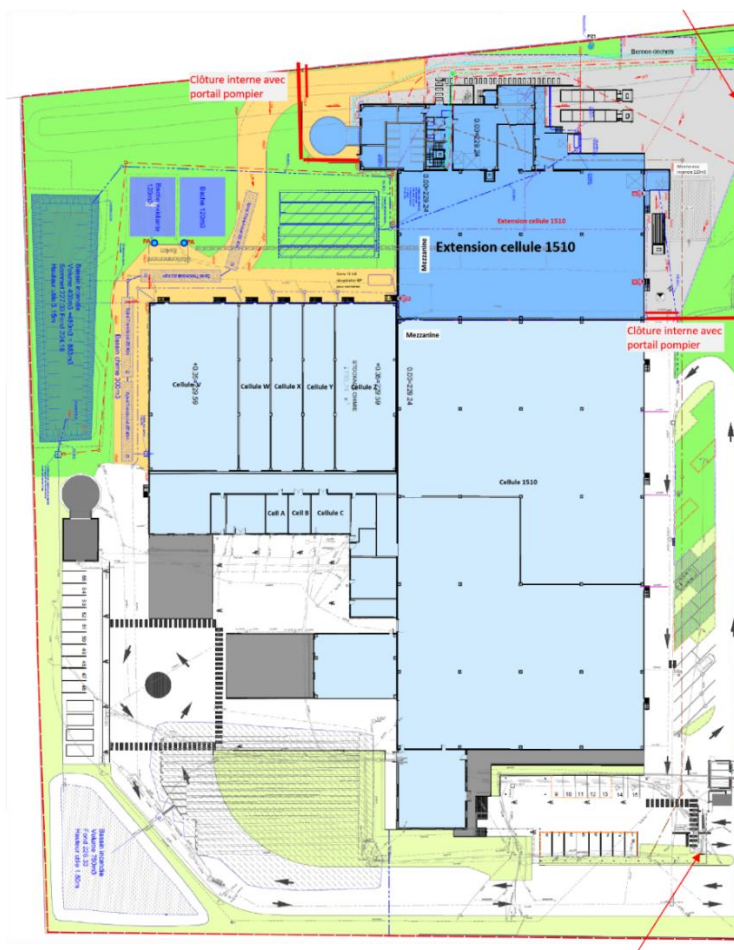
PLAN PROJÉTÉ DU SITE ECTRA (EXTENSION DE LA CELLULE 1510)
